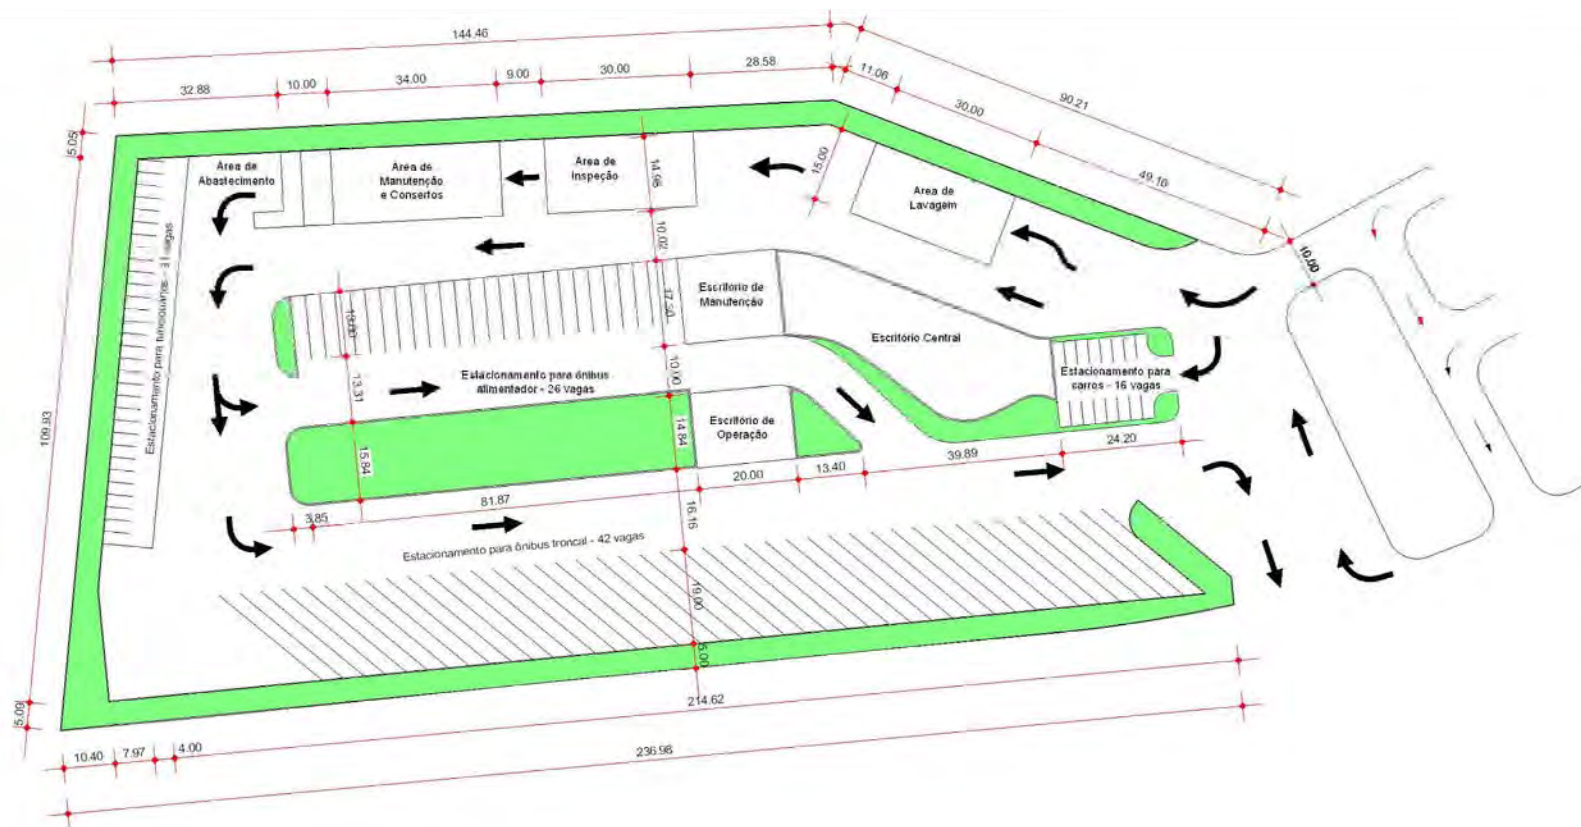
Planta baixa da Gargem Coqueiro
